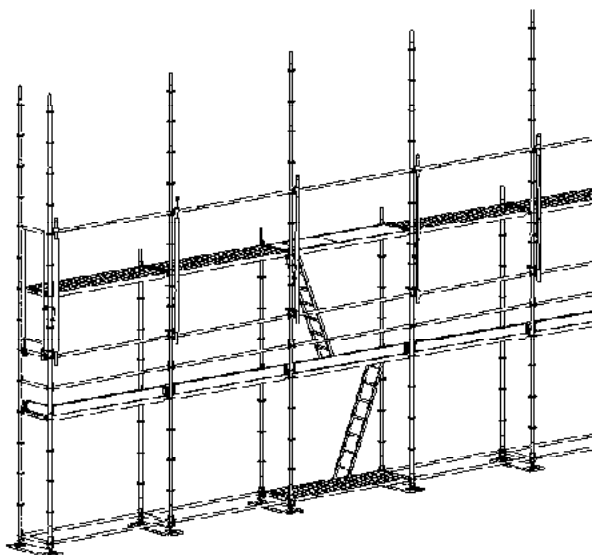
Drugi stupek w konstrukcji wielokondygnacyjnej
